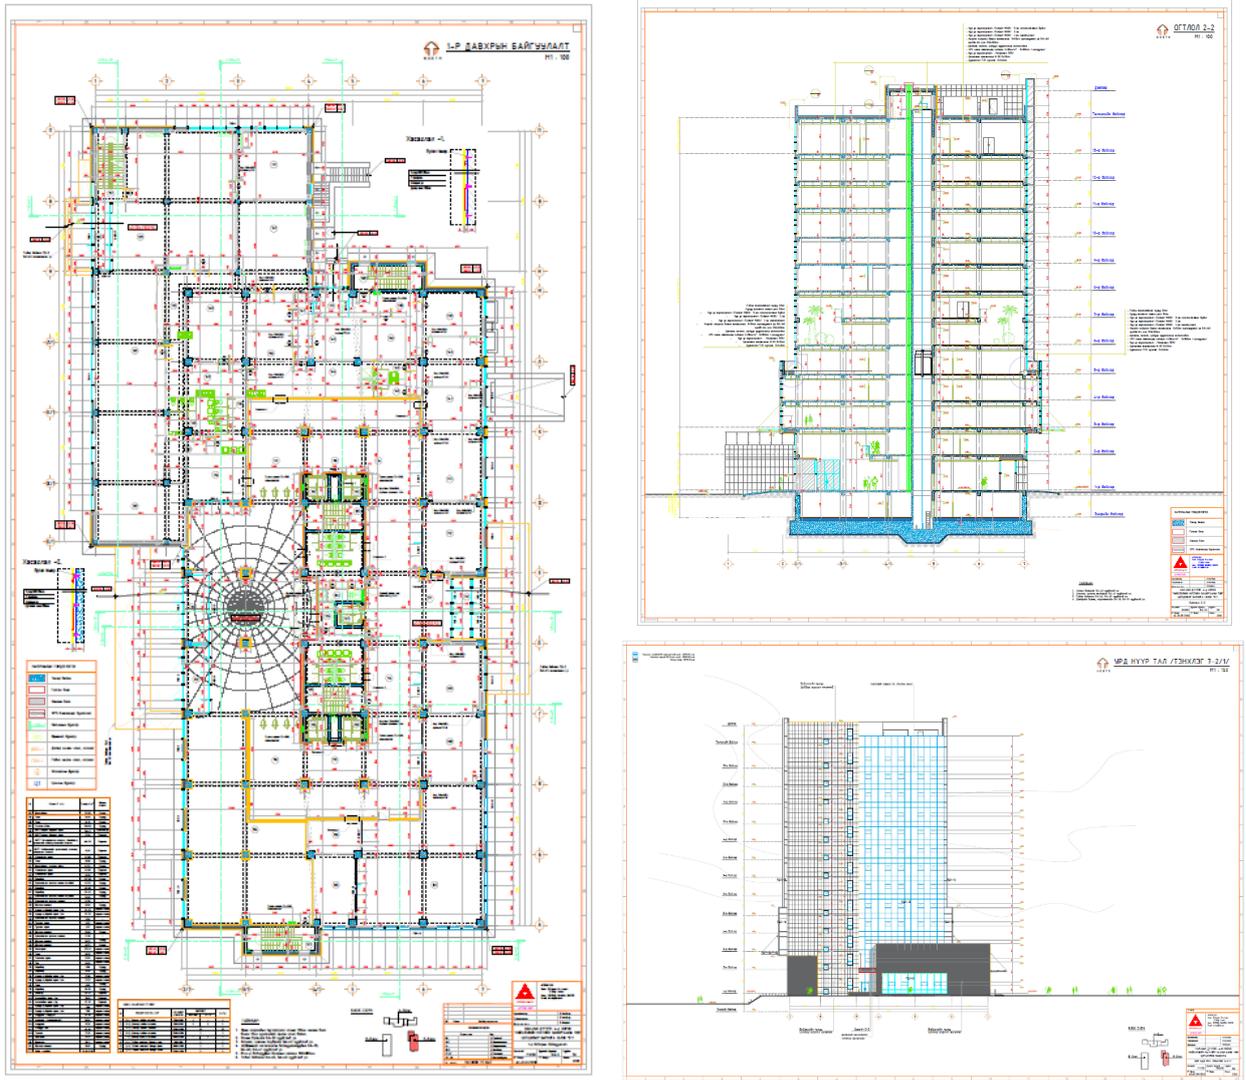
平面図と断面図（ウランバートル市新庁舎 B ブロック）
